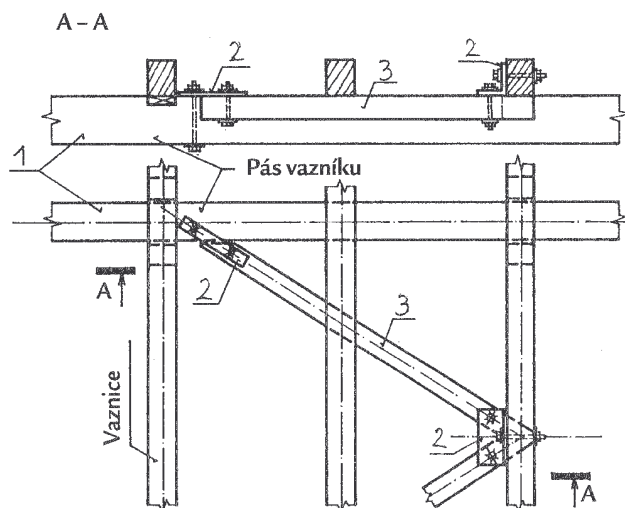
Konstrukční řešení příčného ztužidla:
